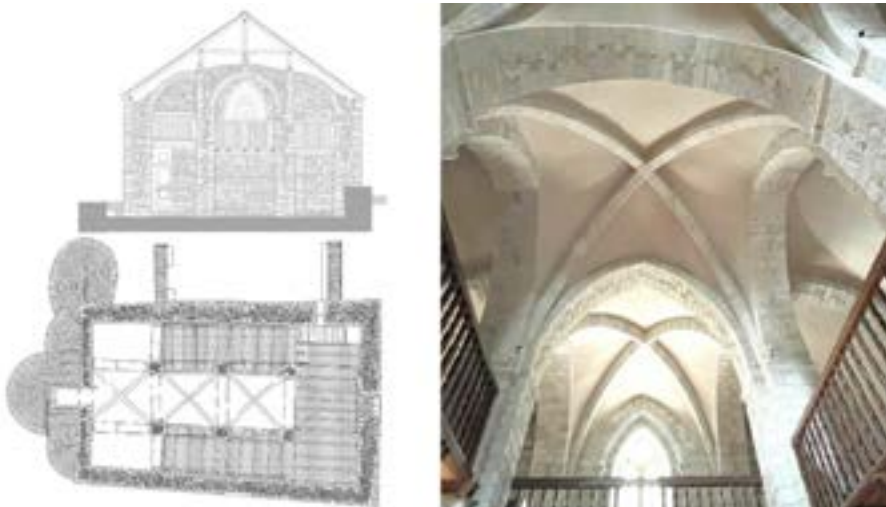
Planta e detalh dera seccion deth còr en anfiteatre de dus trams de Sant Andrèu de Salardú [37]
